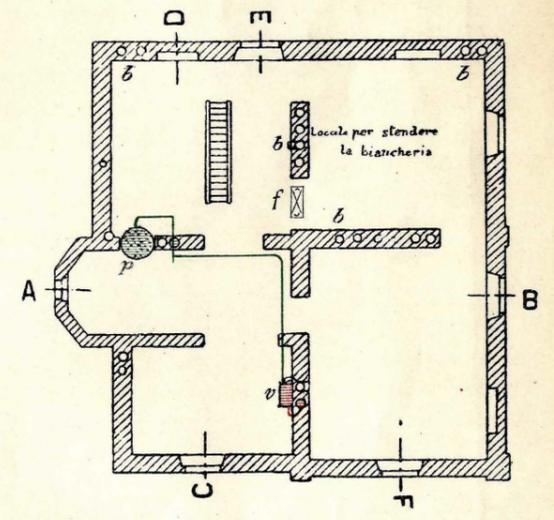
Pianta del sottotetto (Scala 1:200).
